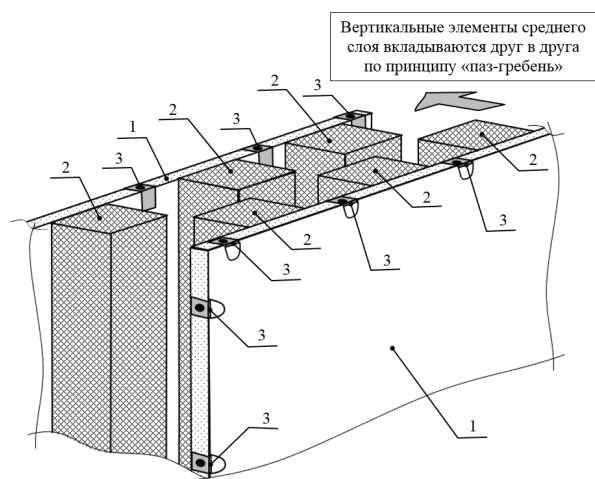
Схема монтажа перегородки из сэндвич-панелей с пазогребневым соединением среднего слоя: 1 – облицовки из листового материала; 2 – вертикальные элементы среднего слоя; 3 – стальные уголки для соединения отдельных панелей между собой и для их крепления к ограждающим конструкциям помещения (стенам, полу, потолку)
